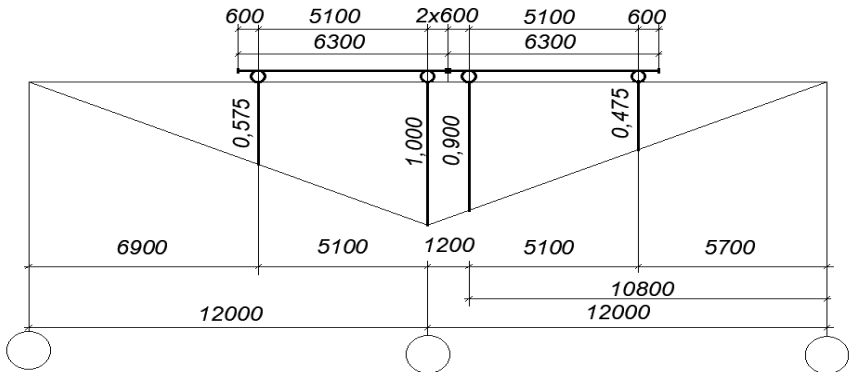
Схема для визначення вертикальних кранових навантажень від двох зближених кранів на середню колону
